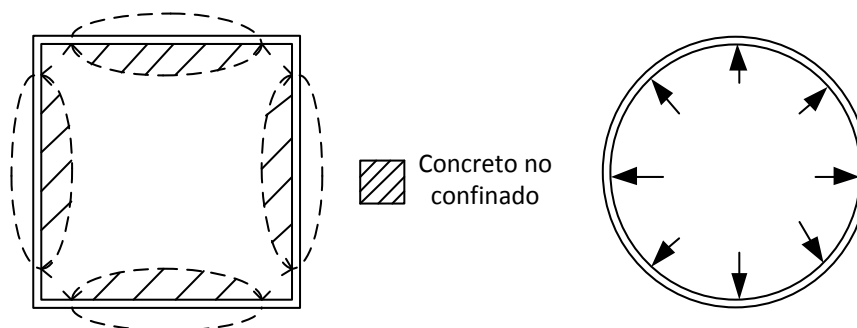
Confinamiento de estribos y refuerzo de hélice (Park y Paulay, 2009).
